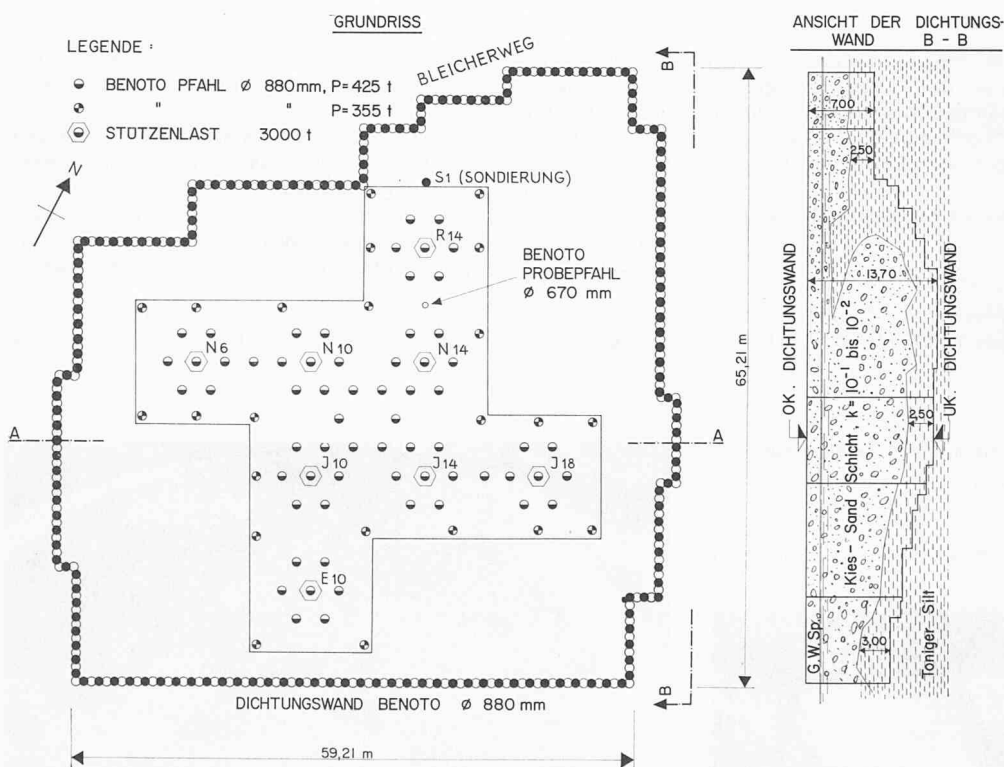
Dichtungswand und Pfahlfundation für die «Palme». Plan 1:800
